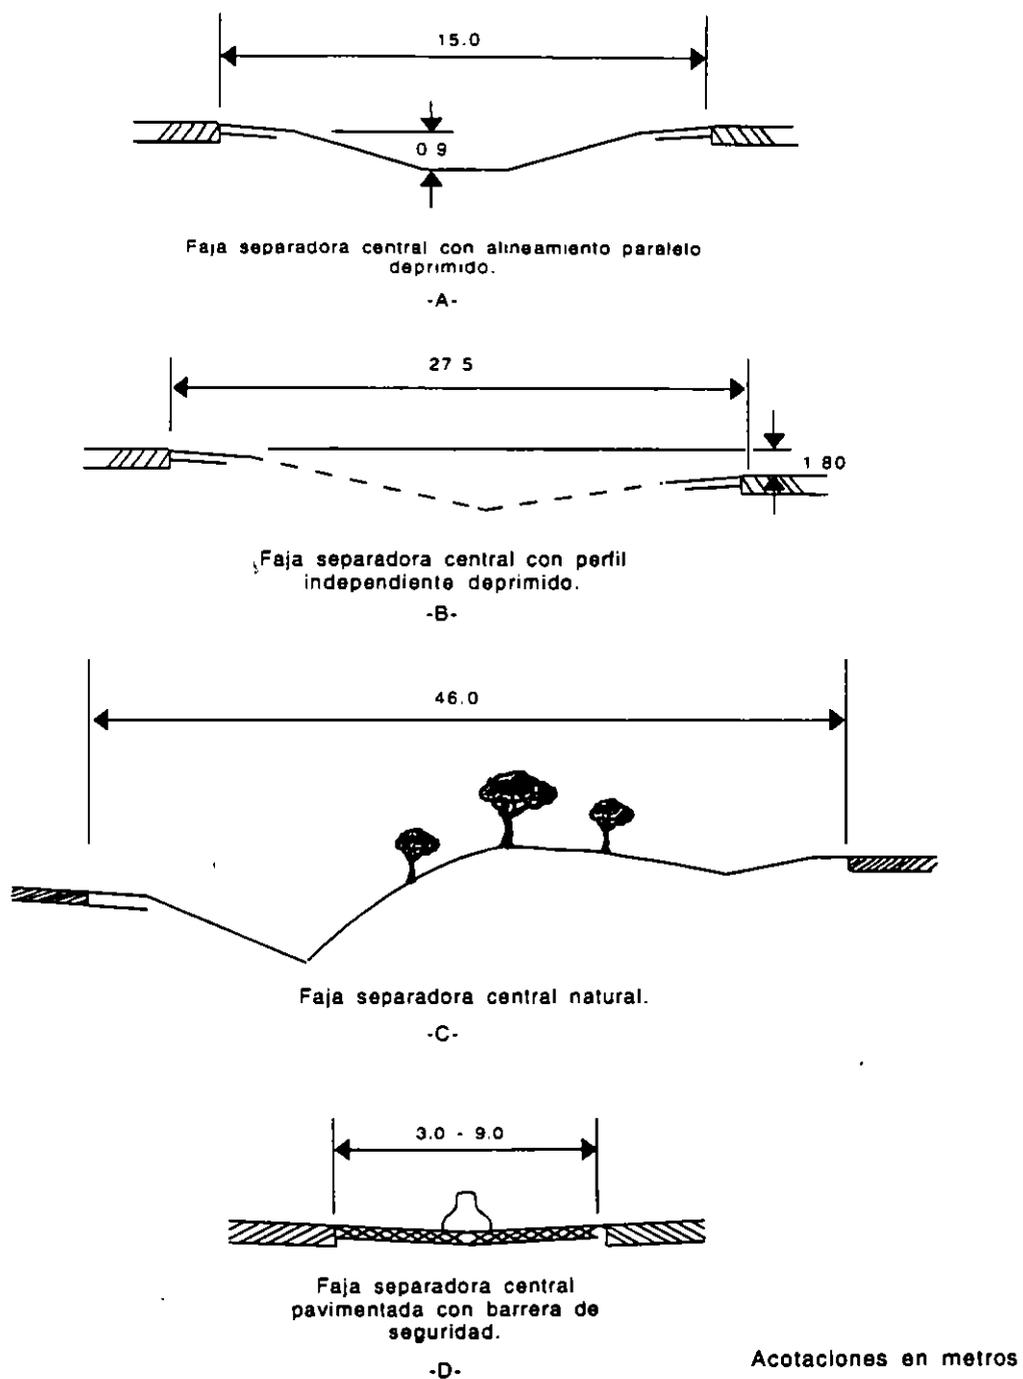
Fajas separadoras centrales típicas en áreas rurales.
